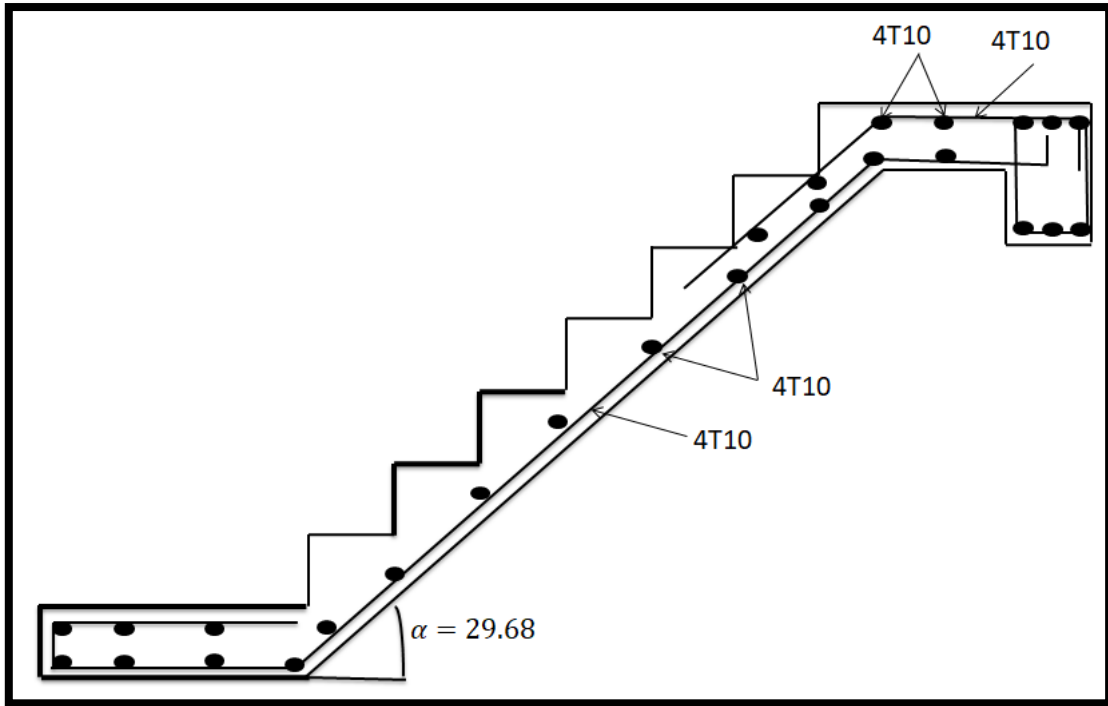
Schéma de ferrailage des escaliers FeE500.
